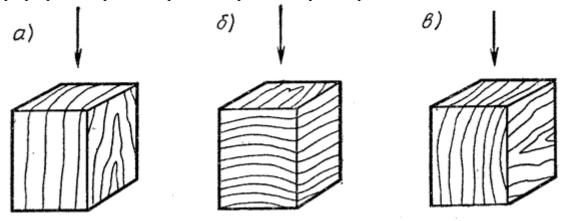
Испытание механических свойств древесины на сжатие: а — вдоль волокон; б — поперек волокон — радиально; в — поперек волокон — тангенциально.
